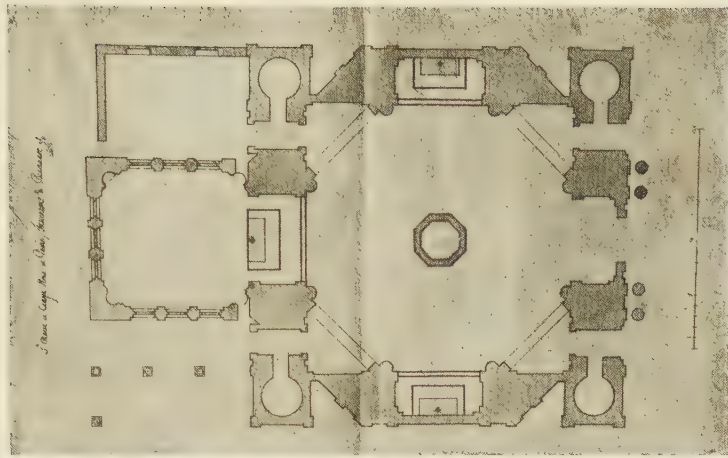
Disegno planimetrico attribuito a Bramante per la chiesa di Canepanova. Archivio di Novara.
